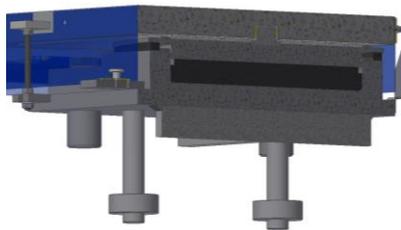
Lagertyp TGe,L, Edelstahlbleche transparent dargestellt, Stahlschluss oben unten Beton, als Verankerung Schubkreuz und Zugverankerung
